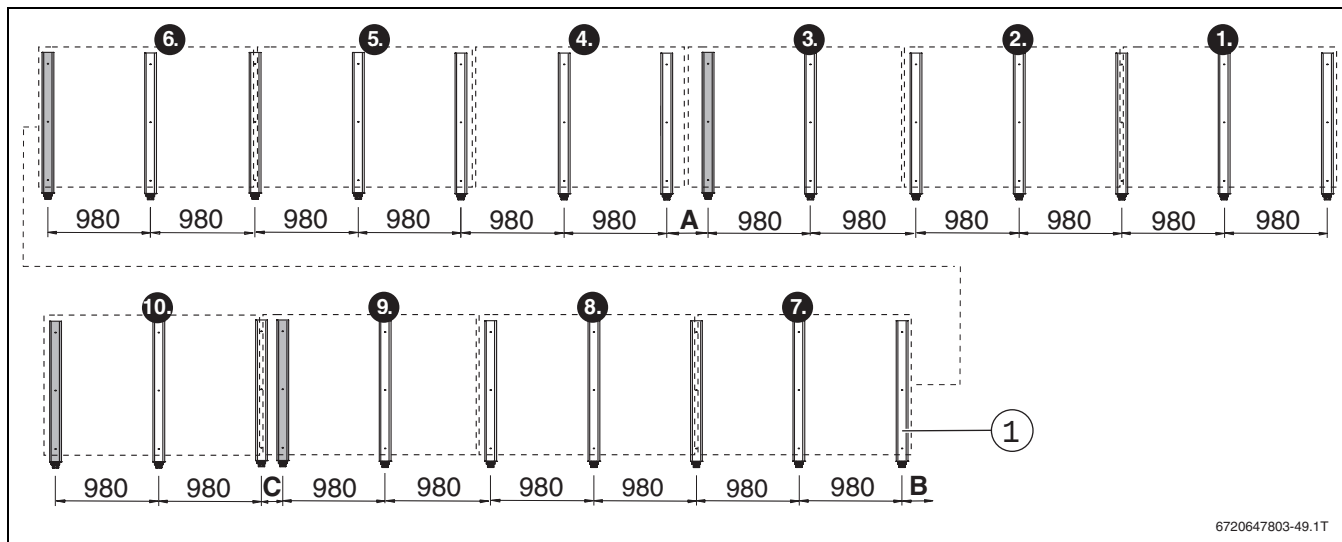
Základné vyhotovenie, 10 zvislých kolektorov (údaje v mm)
